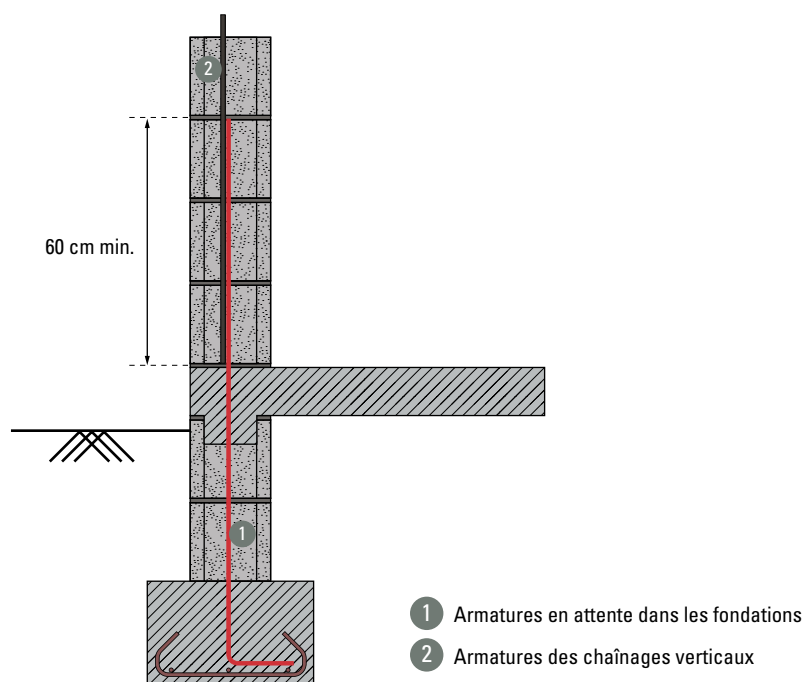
Exemple de liaisons entre armatures de fondations et chaînage vertical
